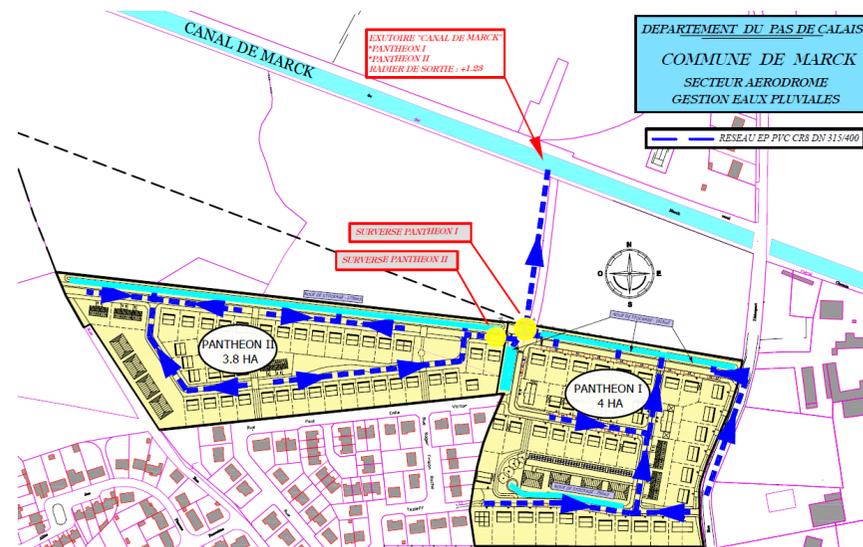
Plan d'assainissement / Gestion des eaux pluviales
